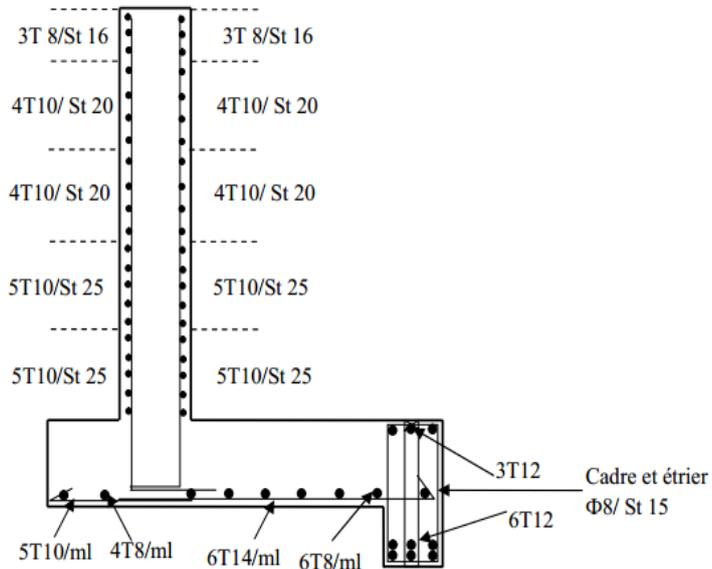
Exemple d'un emplacement idéal de ferrailage d'un mur de soutènement.
